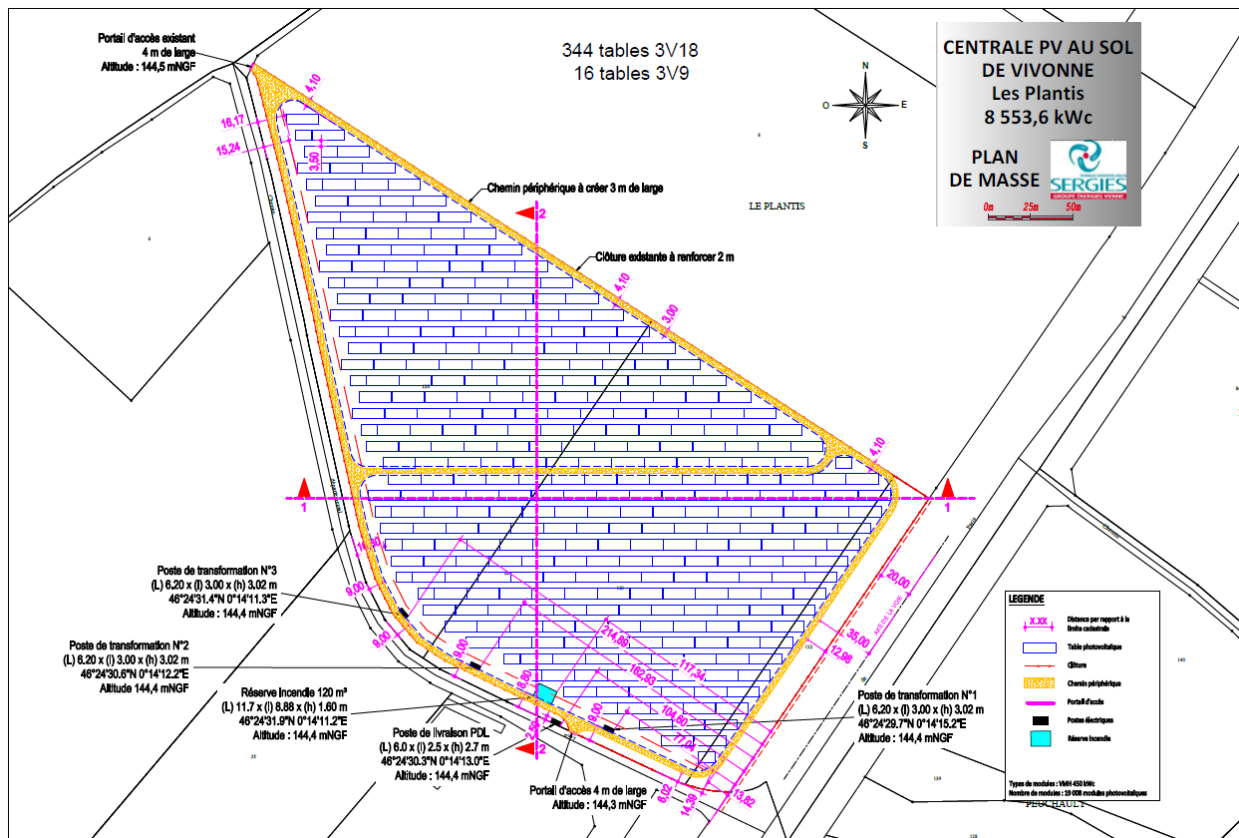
Plan d'implantation de la centrale photovoltaïque
